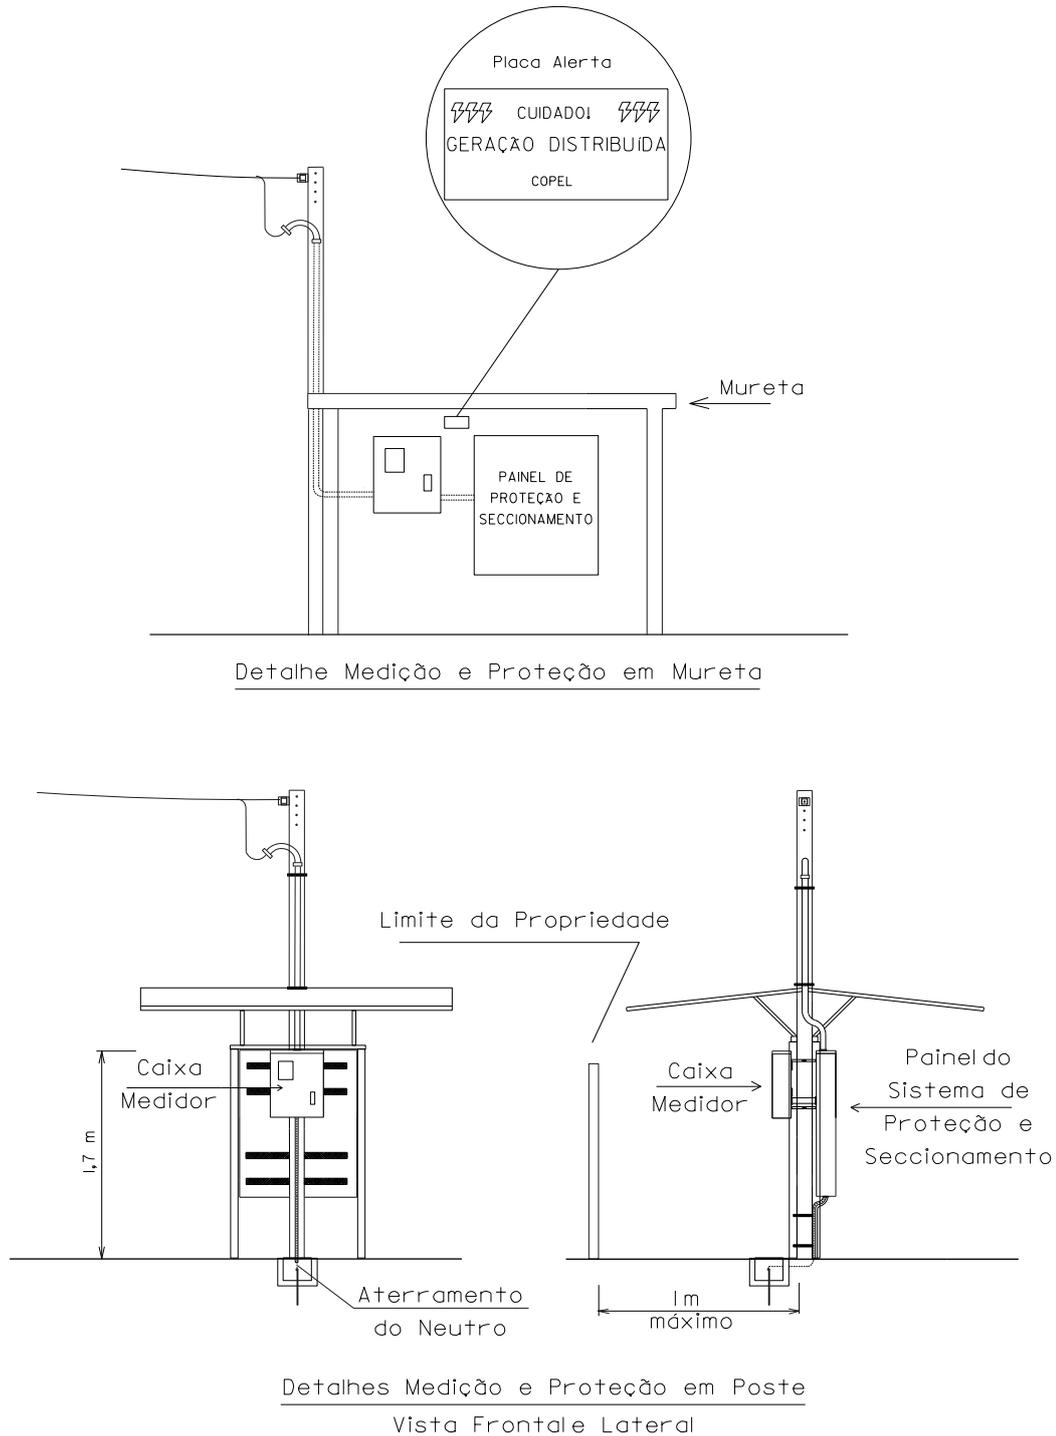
Detalhe construtivo simplificado das instalações de conexão
